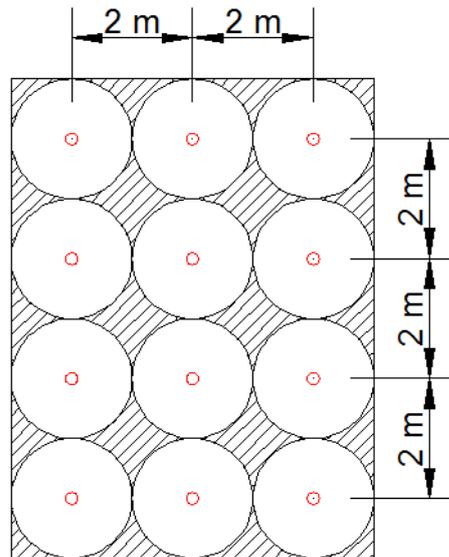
Esquema en planta de voladuras, visto en planta.
